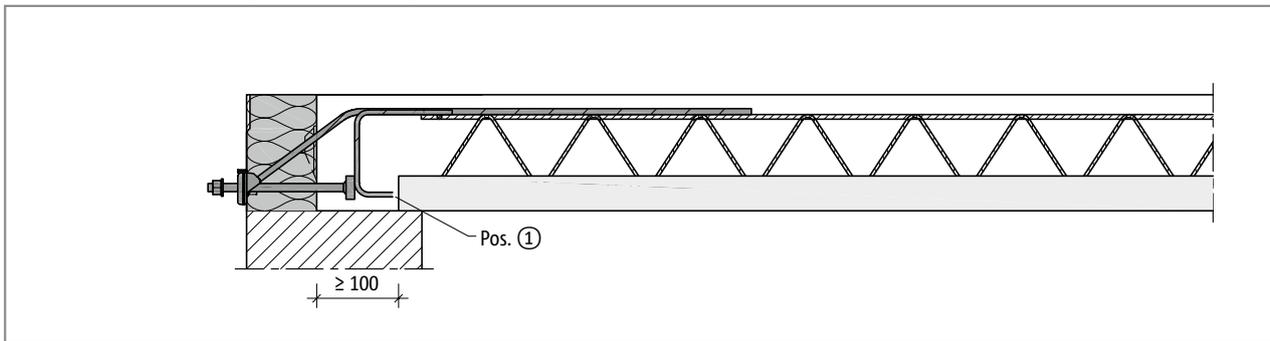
Schöck Isokorb® XT Typ SQ: Bauseitige Bewehrung bei Halbfertigteilbauweise, Schnitt
